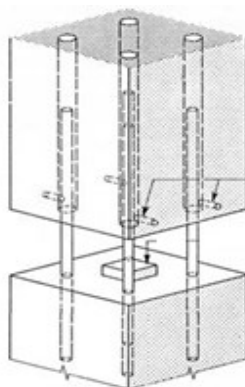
Modelo de ligação pilar-pilar com recurso a emendas (STUPRÉ, 1981).
